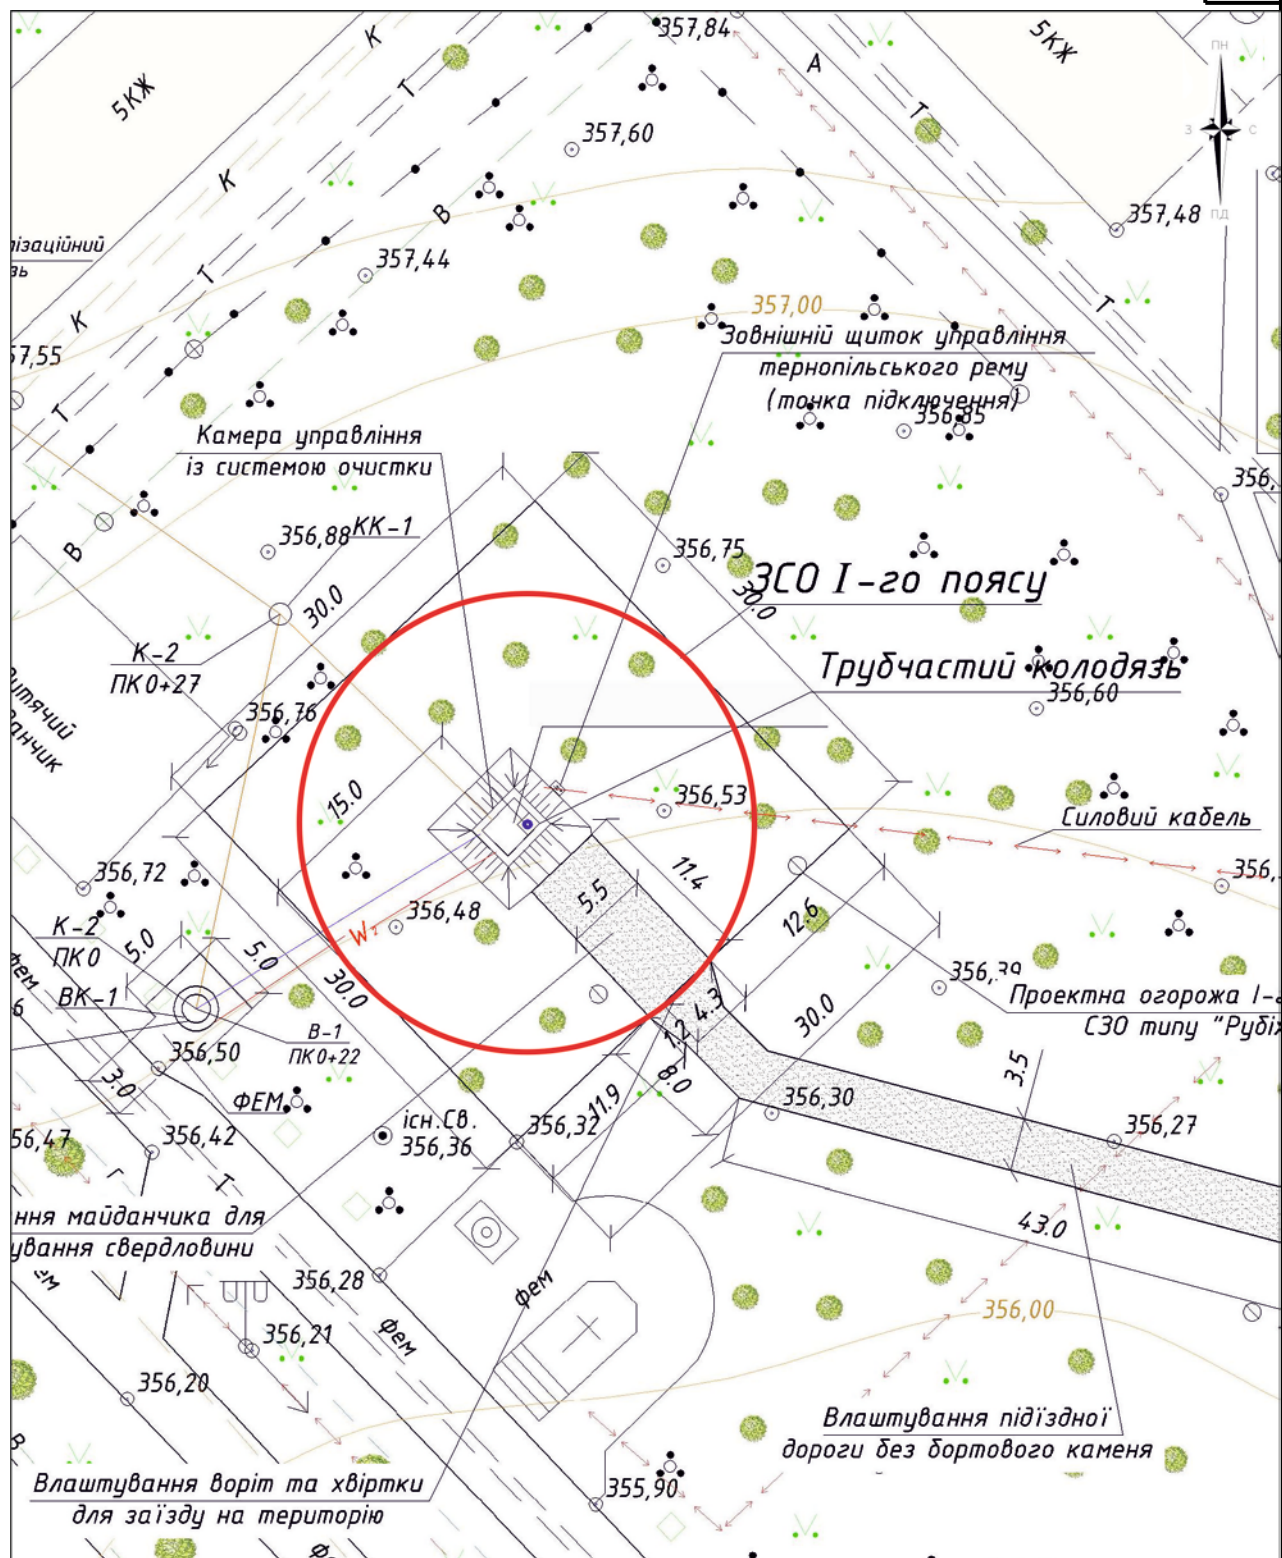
План першого поясу ЗСО свердловини (масштаб 1:500)
